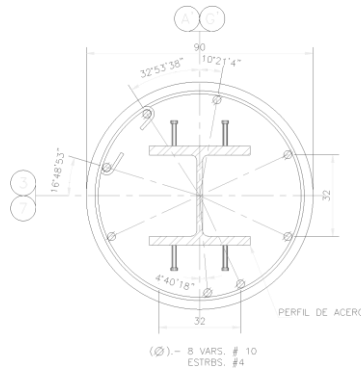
Armado de la columna K5. Tomada del plano estructural.
